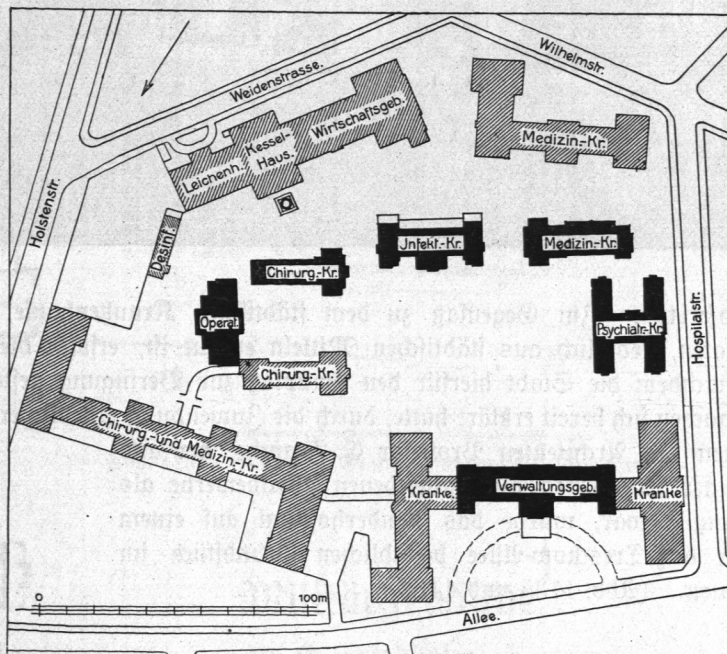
Städtisches Krankenhaus, Lageplan II.
